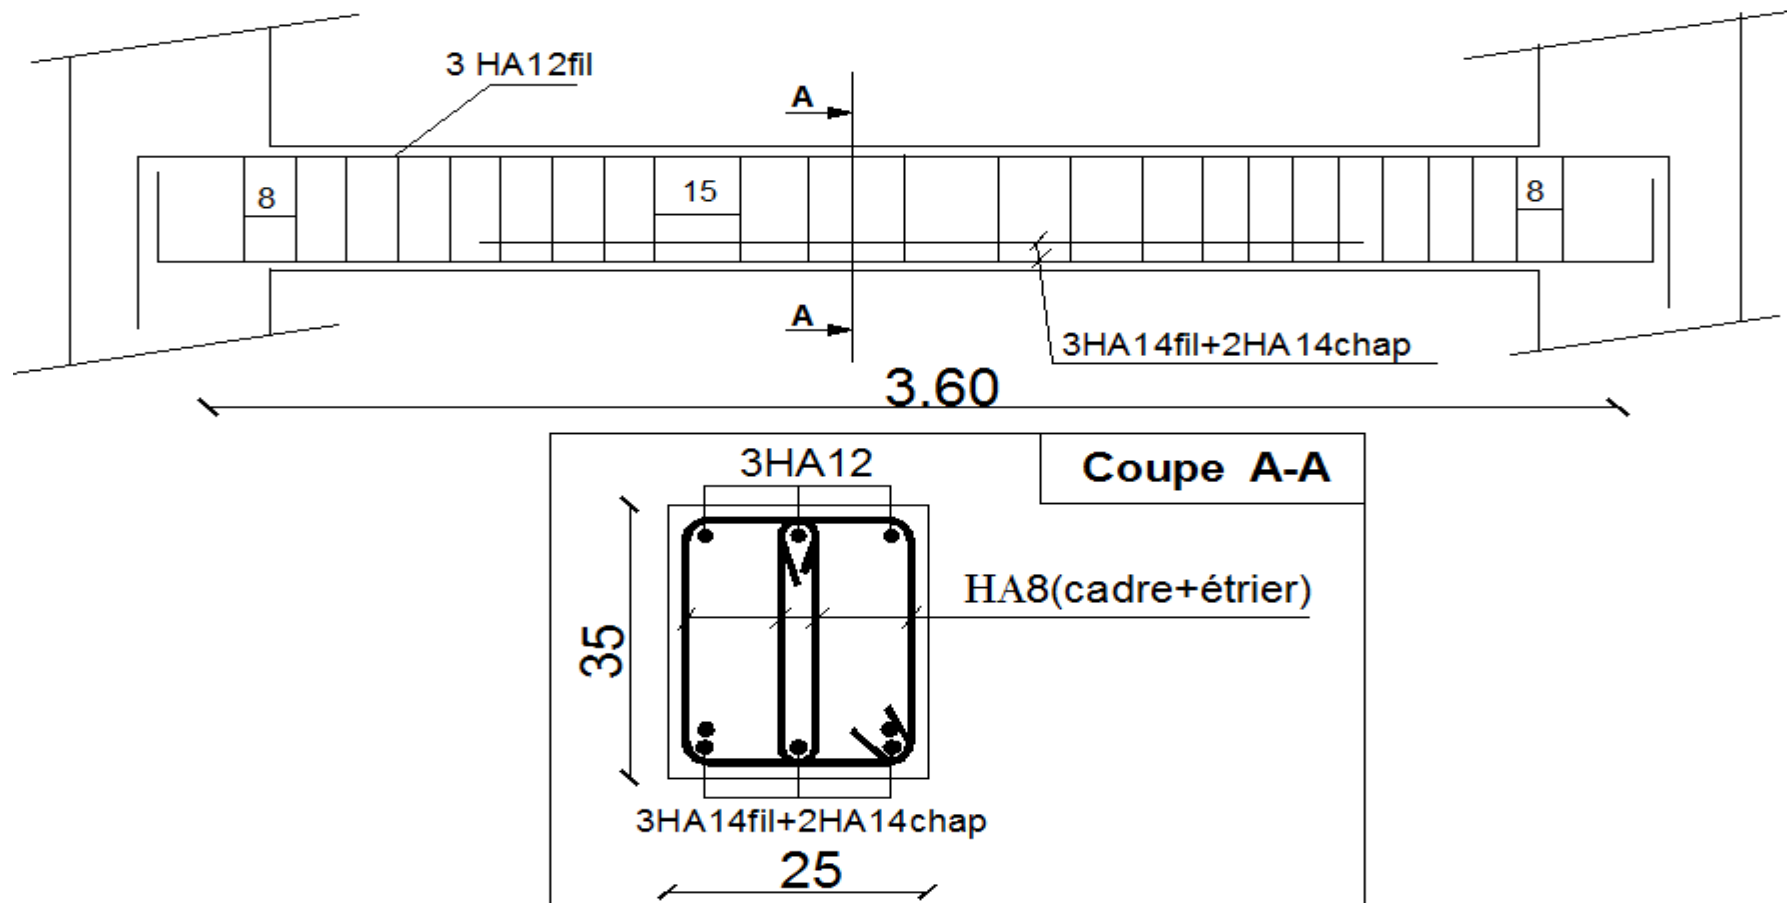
Schéma de ferrailage de la poutre palière.
